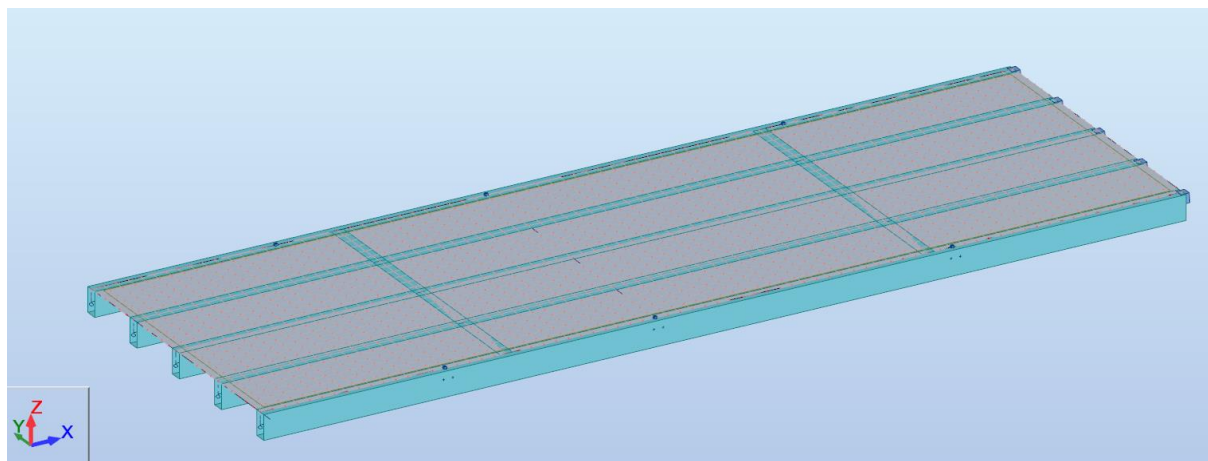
simulação numérica do pavimento PVRR_1
